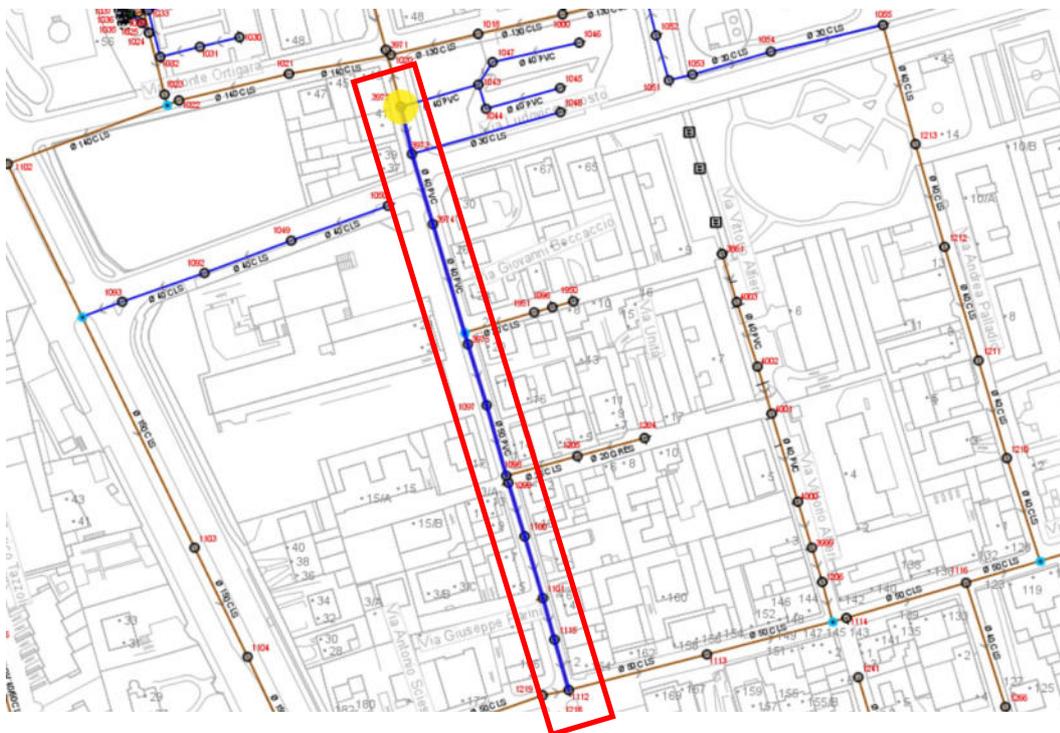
Tratto di rete oggetto di intervento strutturale IS06 (nel rettangolo rosso).
